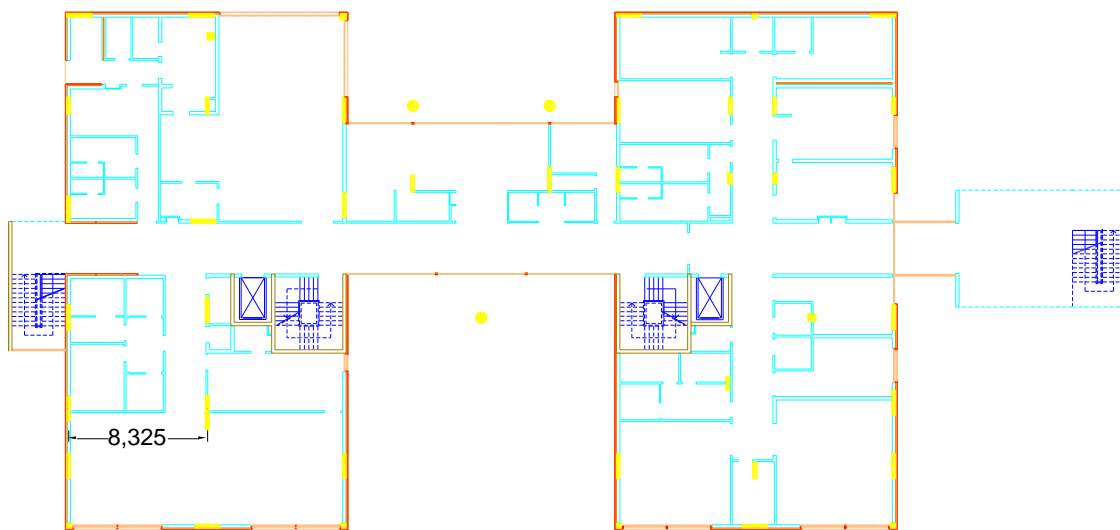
Vão condicionante para o pré-dimensionamento da laje
